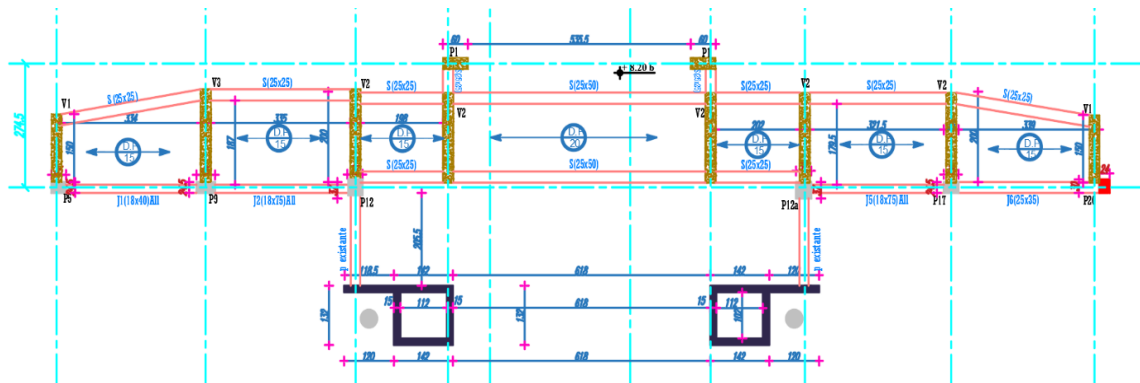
Vue en plan du PH 2ème et 3ème étage de la façade renforcé en béton armé
